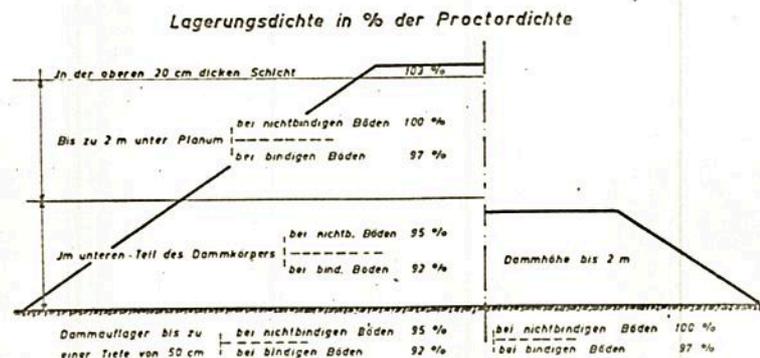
Lagerungsdichte in % der Proctordichte für Dammauflager und Dammkörper (nach ZTVE – StB 59)
